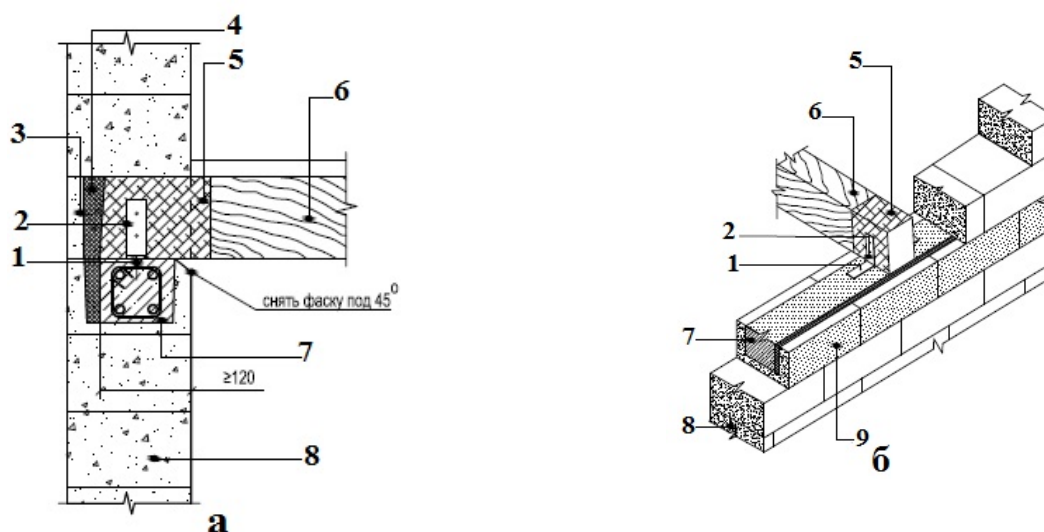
Опираие деревянных балок перекрытия на наружную стену из газобетонных блоков YTONG: а – разрез по стене; б – элемент конструкции; 1 — дюбель-винт; 2 — соединитель; 3 — доборный блок YTONG; 4 — минераловатный утеплитель; 5 — рубероид, обернутый вокруг деревянной балки; 6 — деревянная балка перекрытия; 7 — железобетонный пояс; 8 — блок YTONG; 9 — U-образный блок
